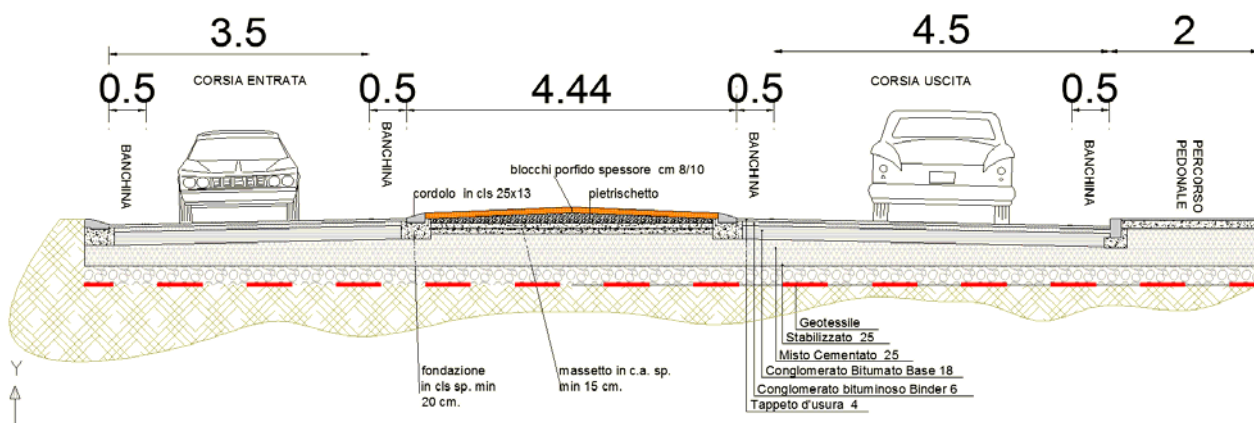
Sezione di progetto ingresso-uscita dalla rotatoria
